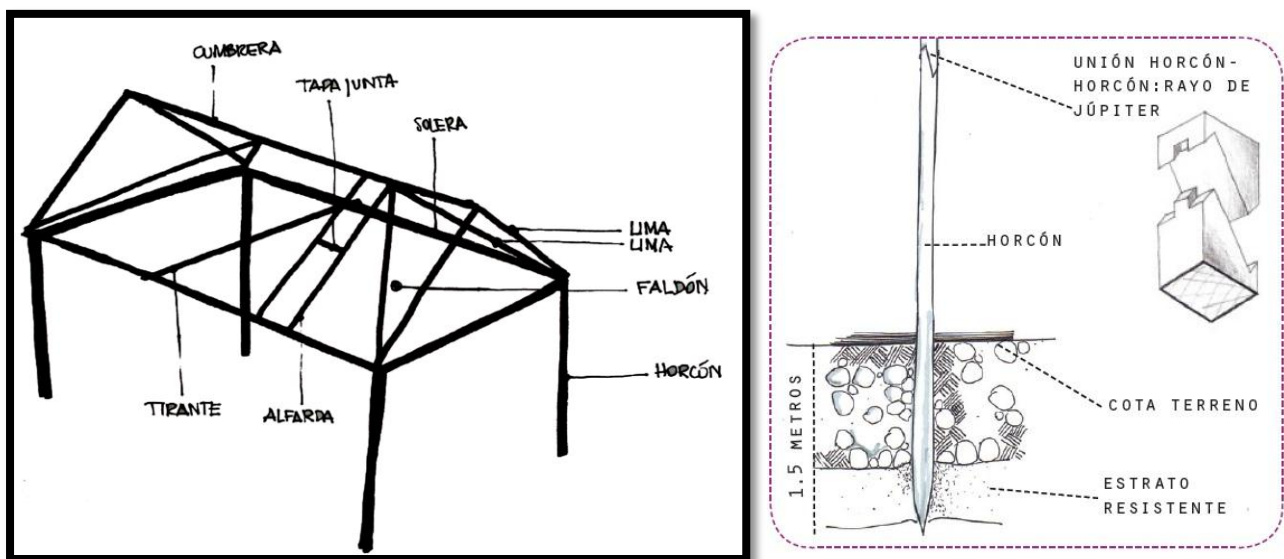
Esquema estructura columnar-arquitrabada y horcón de madera, respectivamente.<sup>9</sup>
